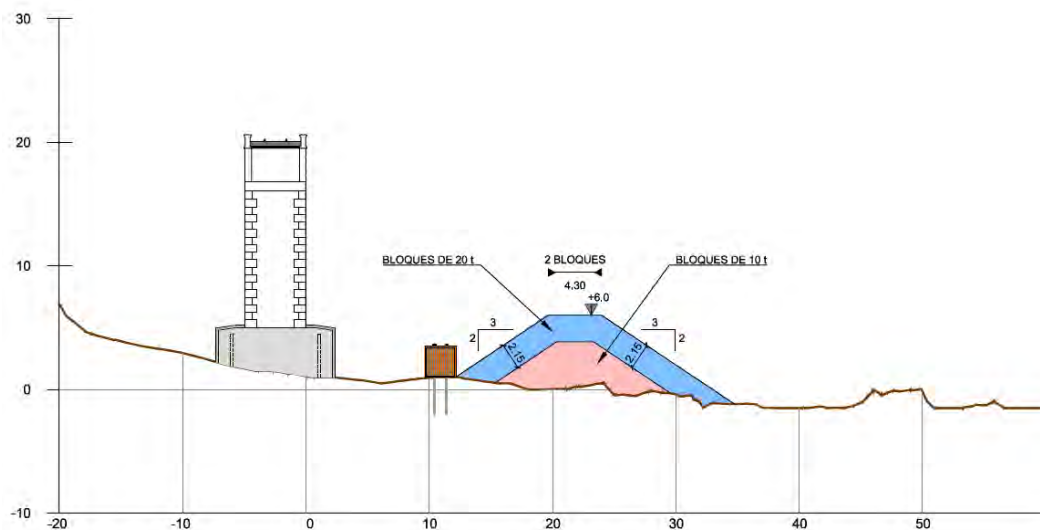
Sección tipo bloques 10 t y 20 t hasta un alcance máximo de la grúa de 65 m.
